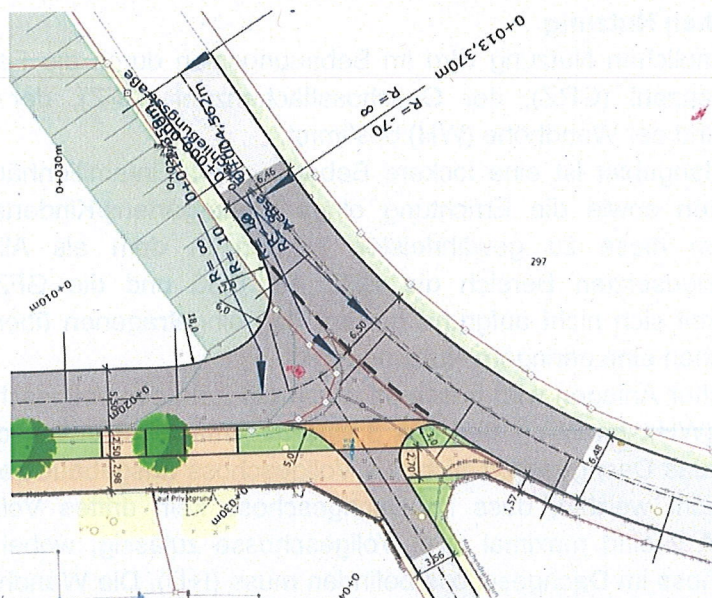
Ausschnitt: Erschließungsstraße – Einmündung in die Kreisstraße
